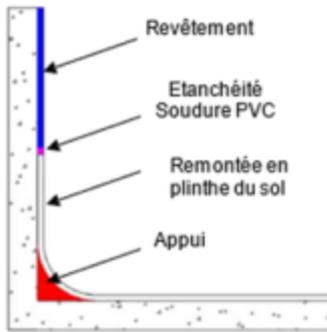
Remontée en plinthe sur sol PVC : soudage/joint direct (uniquement pièces sèches)
